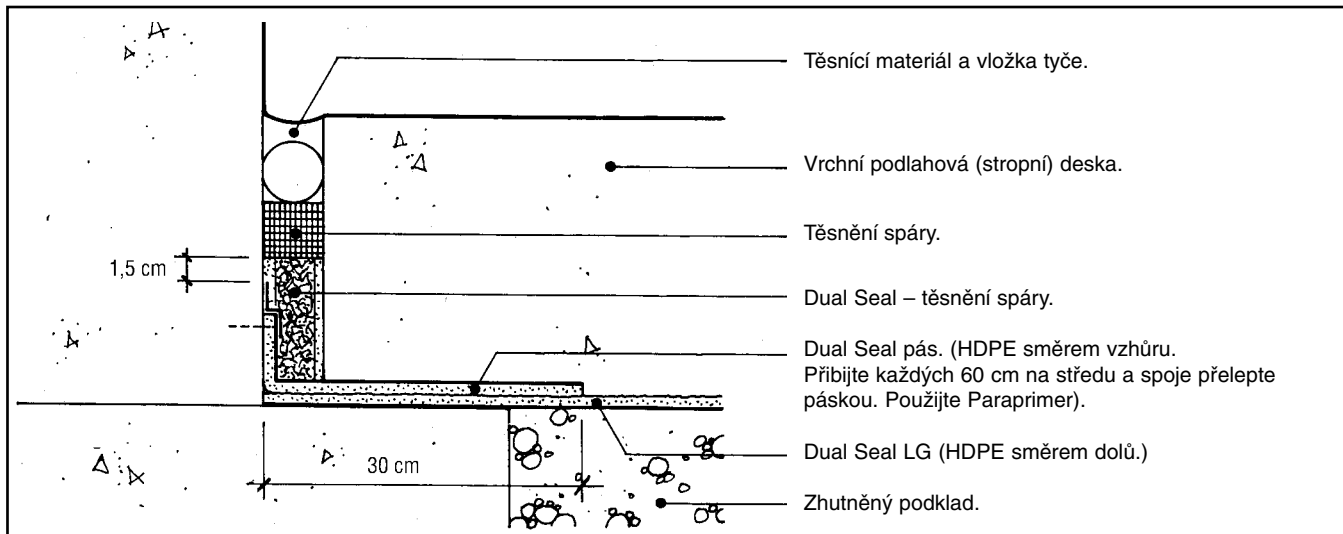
Izolace podlahy s napojením k vnitřní straně zdi – HDPE strana směrem dolů.
